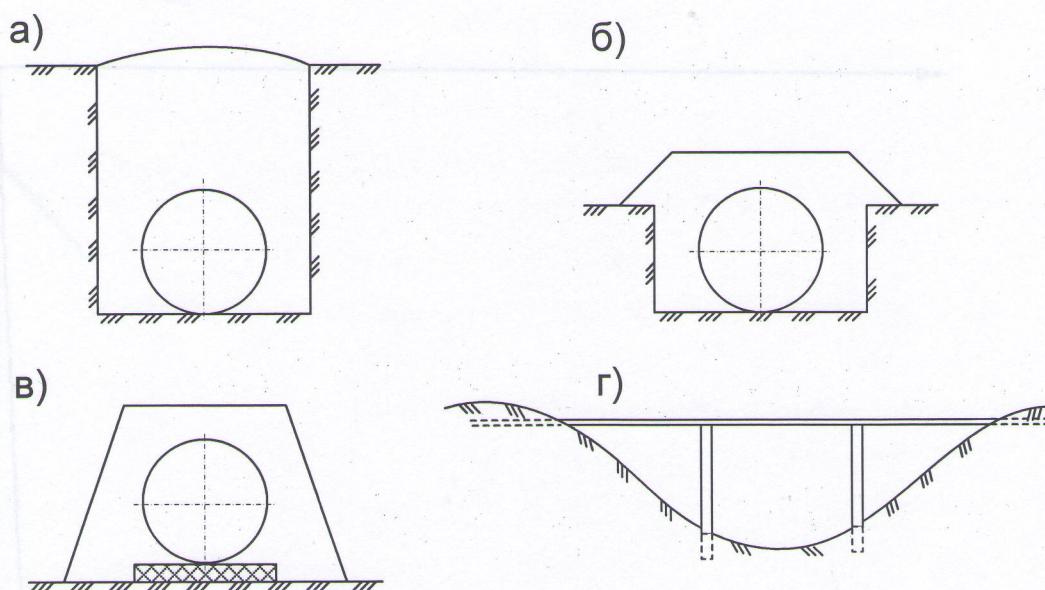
Схемы прокладки трубопроводов: а) подземная; б) полуподземная; в) наземная; г) надземная
